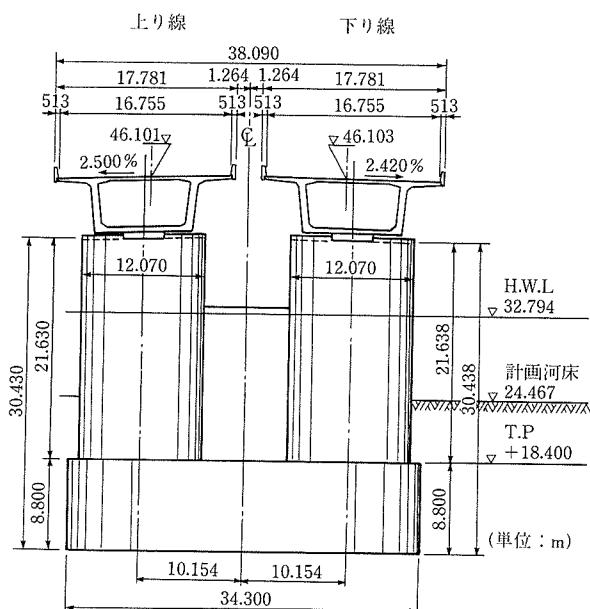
橋梁断面図(ケーソン基礎P8~P17の標準部)
